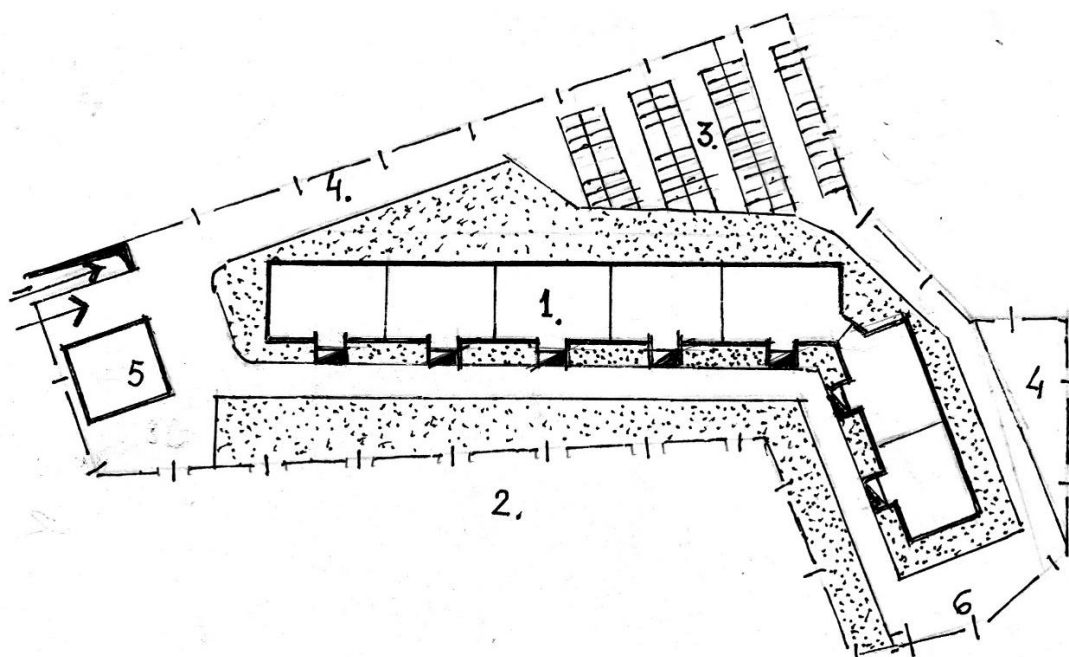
Схема генплана проектируемого 10 этажного 7 секционного жилого дома на 389 квартир с общей площадью квартир 17763 м<sup>2</sup> в МКР №3 Арбеково по ул. Ладожской 146.
